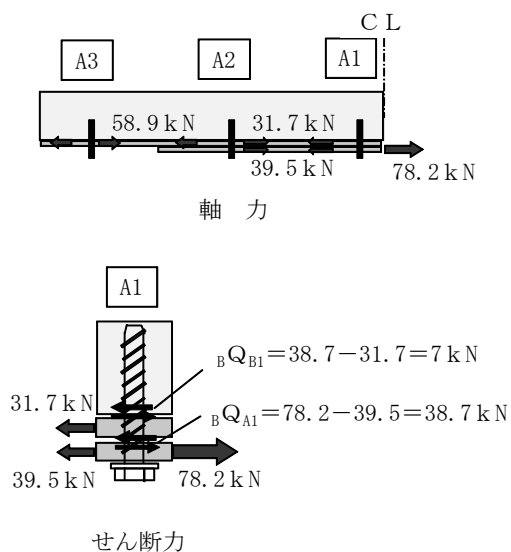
試験体 KTC 鋼板負担力と位置 A1 アンカーのせん断力
